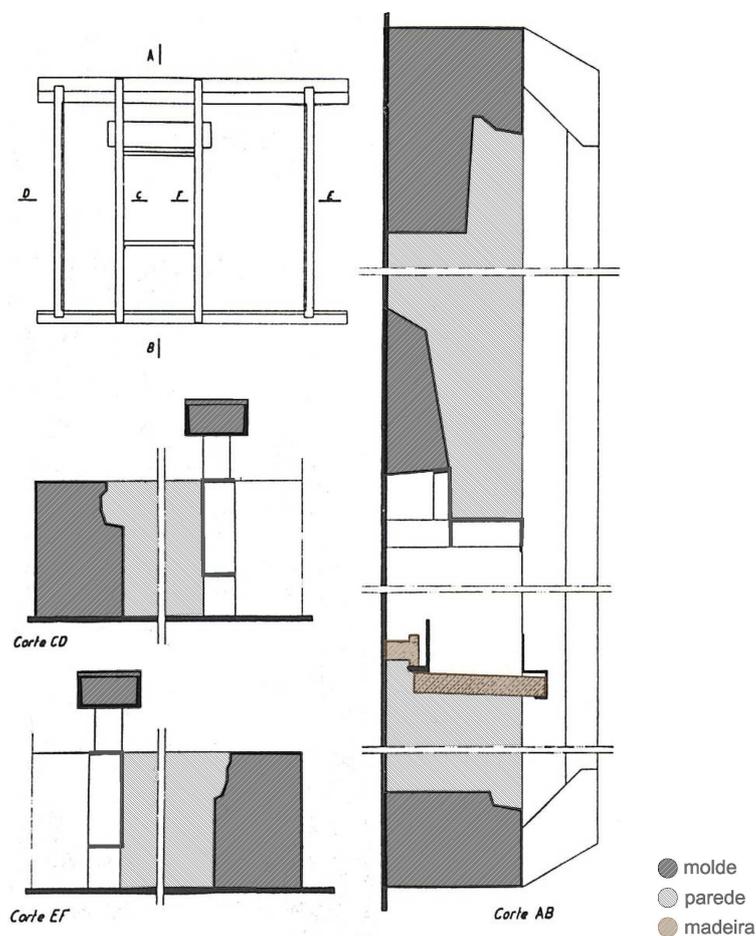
Esquema de montagem de molde para painel de fachada com vão.
